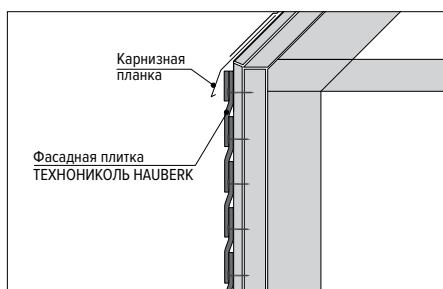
Монтаж верхнего ряда в домах без карнизного свеса
